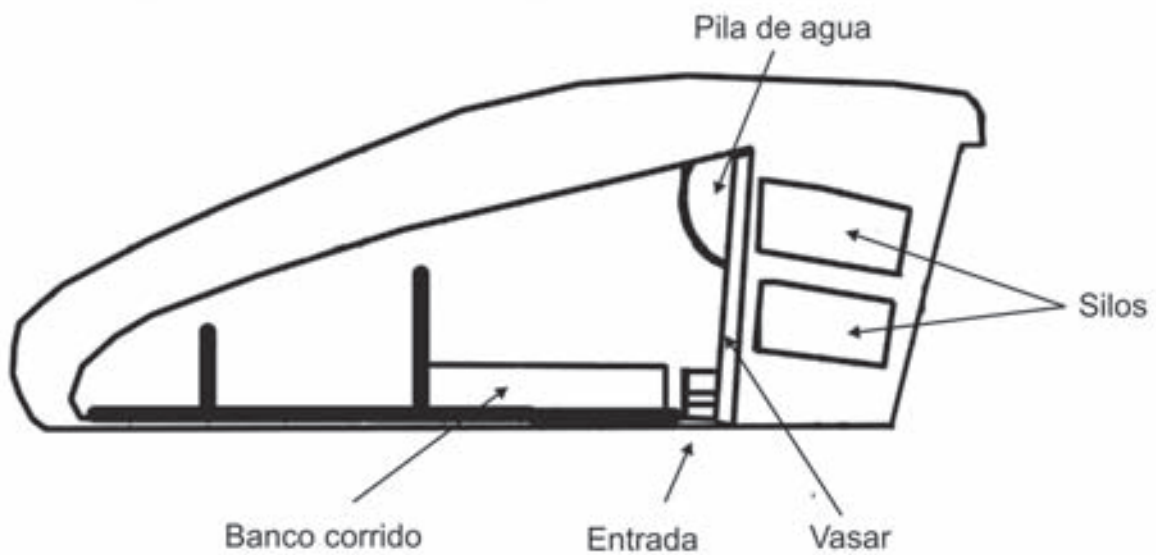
Planta de casa rectangular tripartita, excavada en la roca, en la zona alta del yacimiento de Tiermes (Soria).
